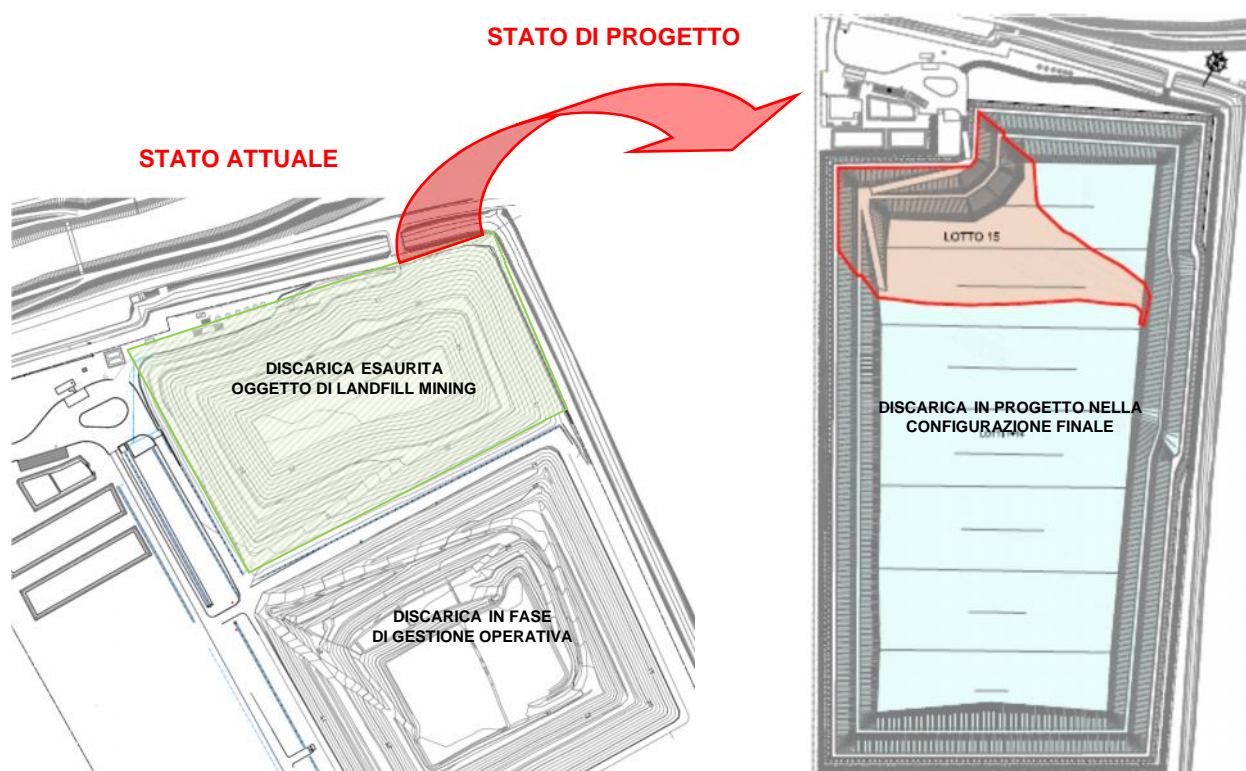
Planimetria delle aree di intervento. Assetto attuale e assetto di progetto
